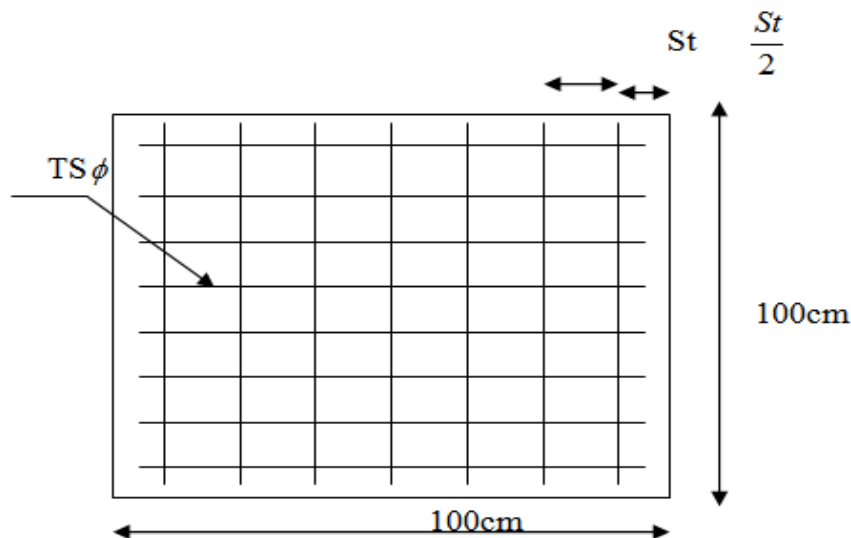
Schéma de ferrailage de la dalle de compression.
